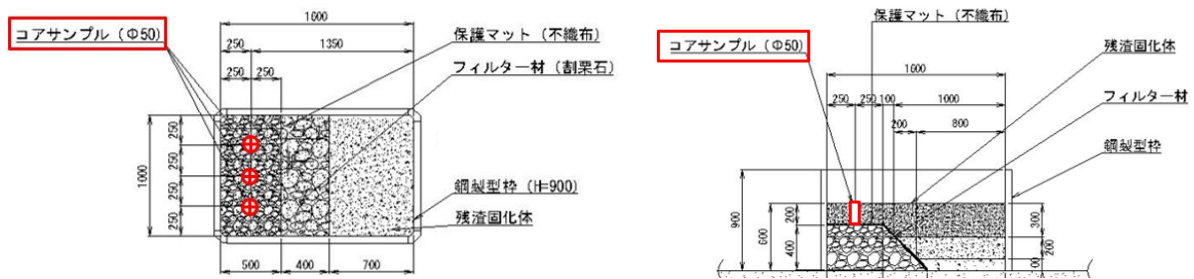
フィルター材との水平接合部でのコア採取位置(左:平面図、右:縦断)
